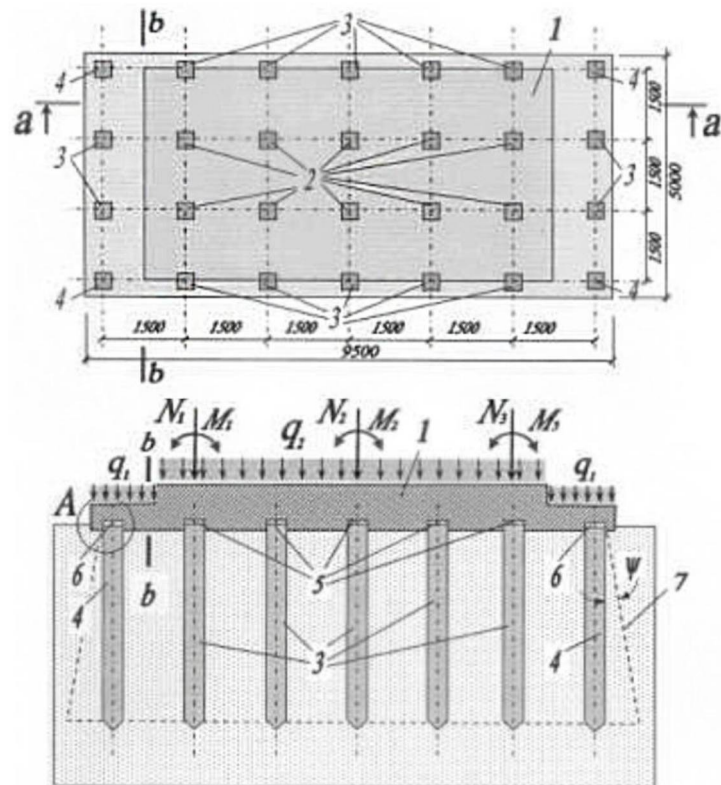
Плитно-пальовий фундамент В.В. Лушнікова: а) схема в плані; б) розріз; 1 - плита; 2 - центральні палі; 3 - крайні палі; 4 - кутові палі; 5, 6 - прокладки; 7 - умовний фундамент
